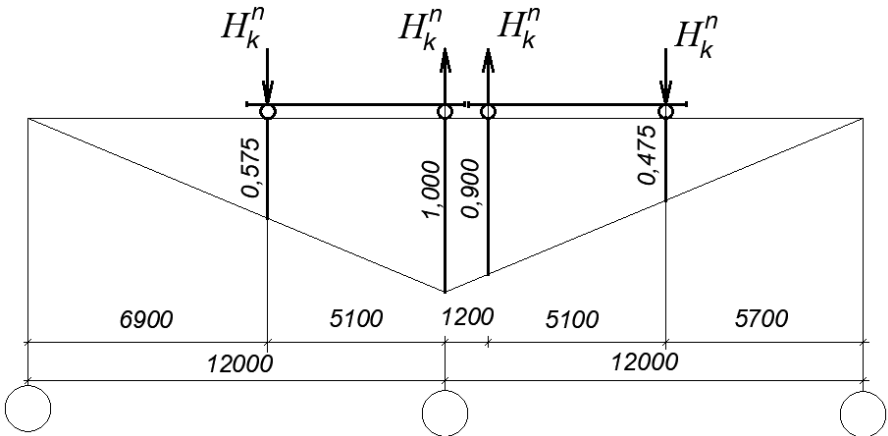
Схема для визначення горизонтальних кранових бічних навантажень від двох зближених кранів на середню опору за першим рекомендованим варіантом для правої сторони крана
